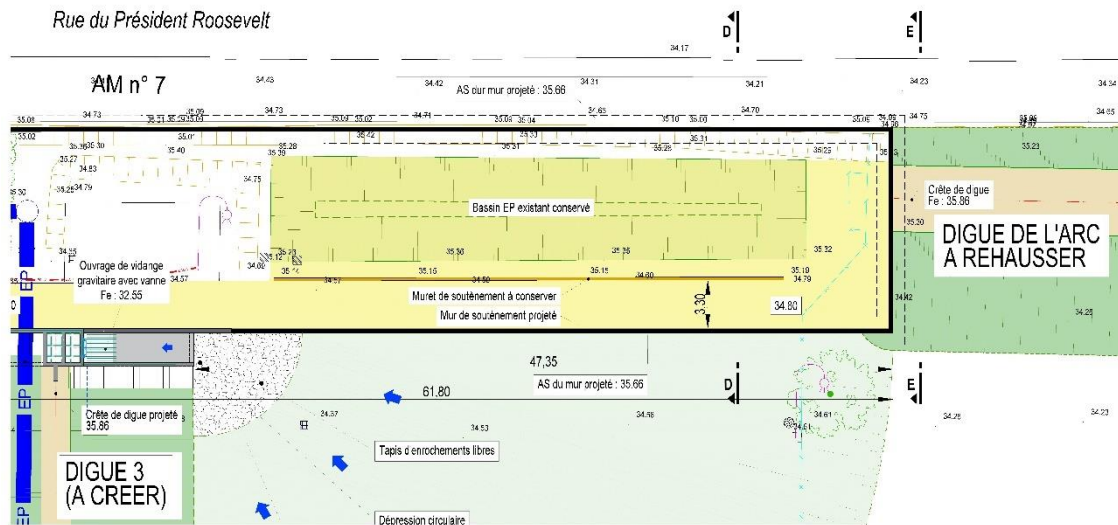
Plan et coupe du mur de clôture du bassin de compensation
